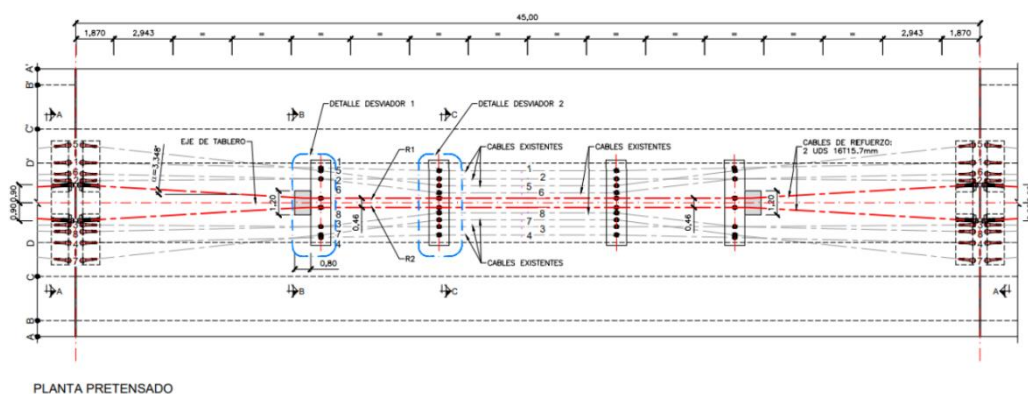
Planta de pretensado del proyecto de reparación [5], con los cables de refuerzo indicados en rojo. (Fuente: [5]).
